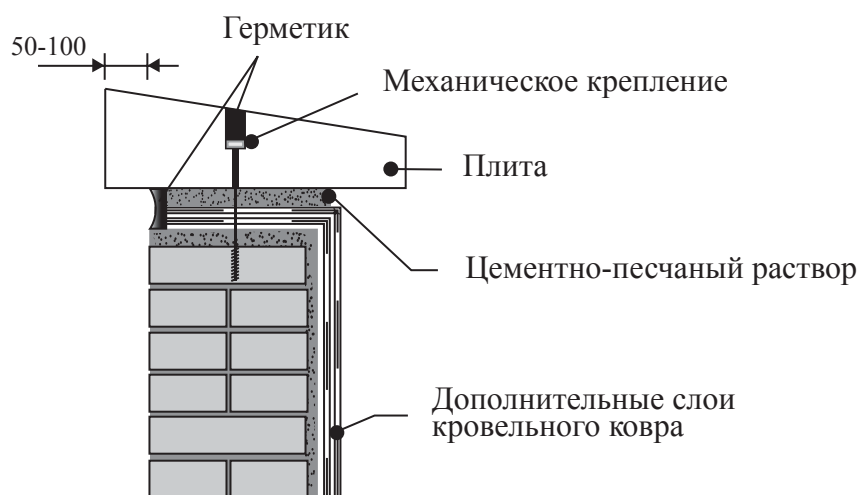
Примыкание кровельной системы к парапетной стене с парапетным камнем.
